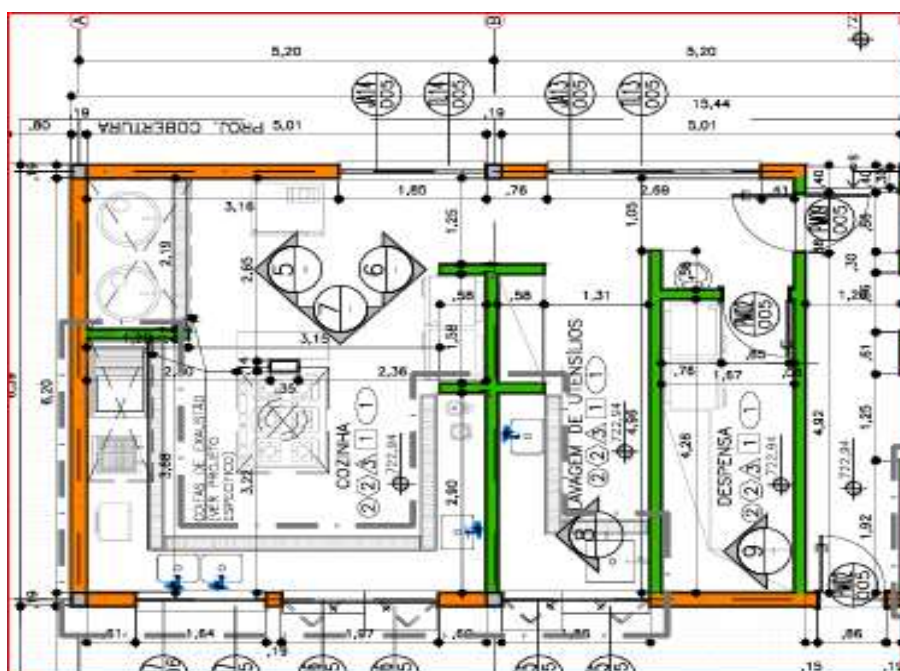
Projeto planta baixa da cozinha - fonte:própria
